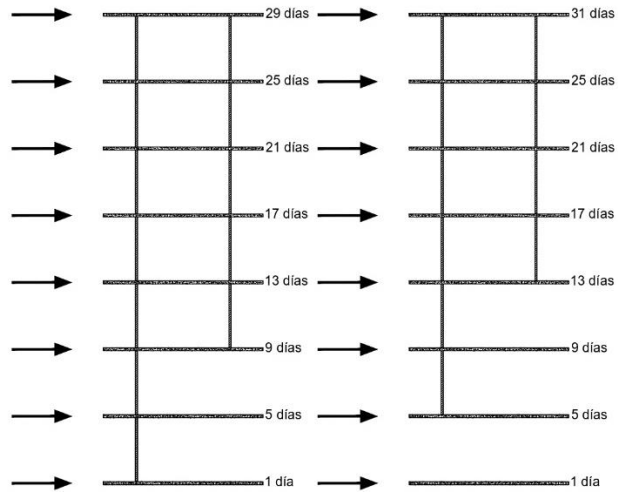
(cont.). Secuencia de apuntalamiento y desapuntalamiento para una losa de una planta de entrepiso colada en cuatro secciones
